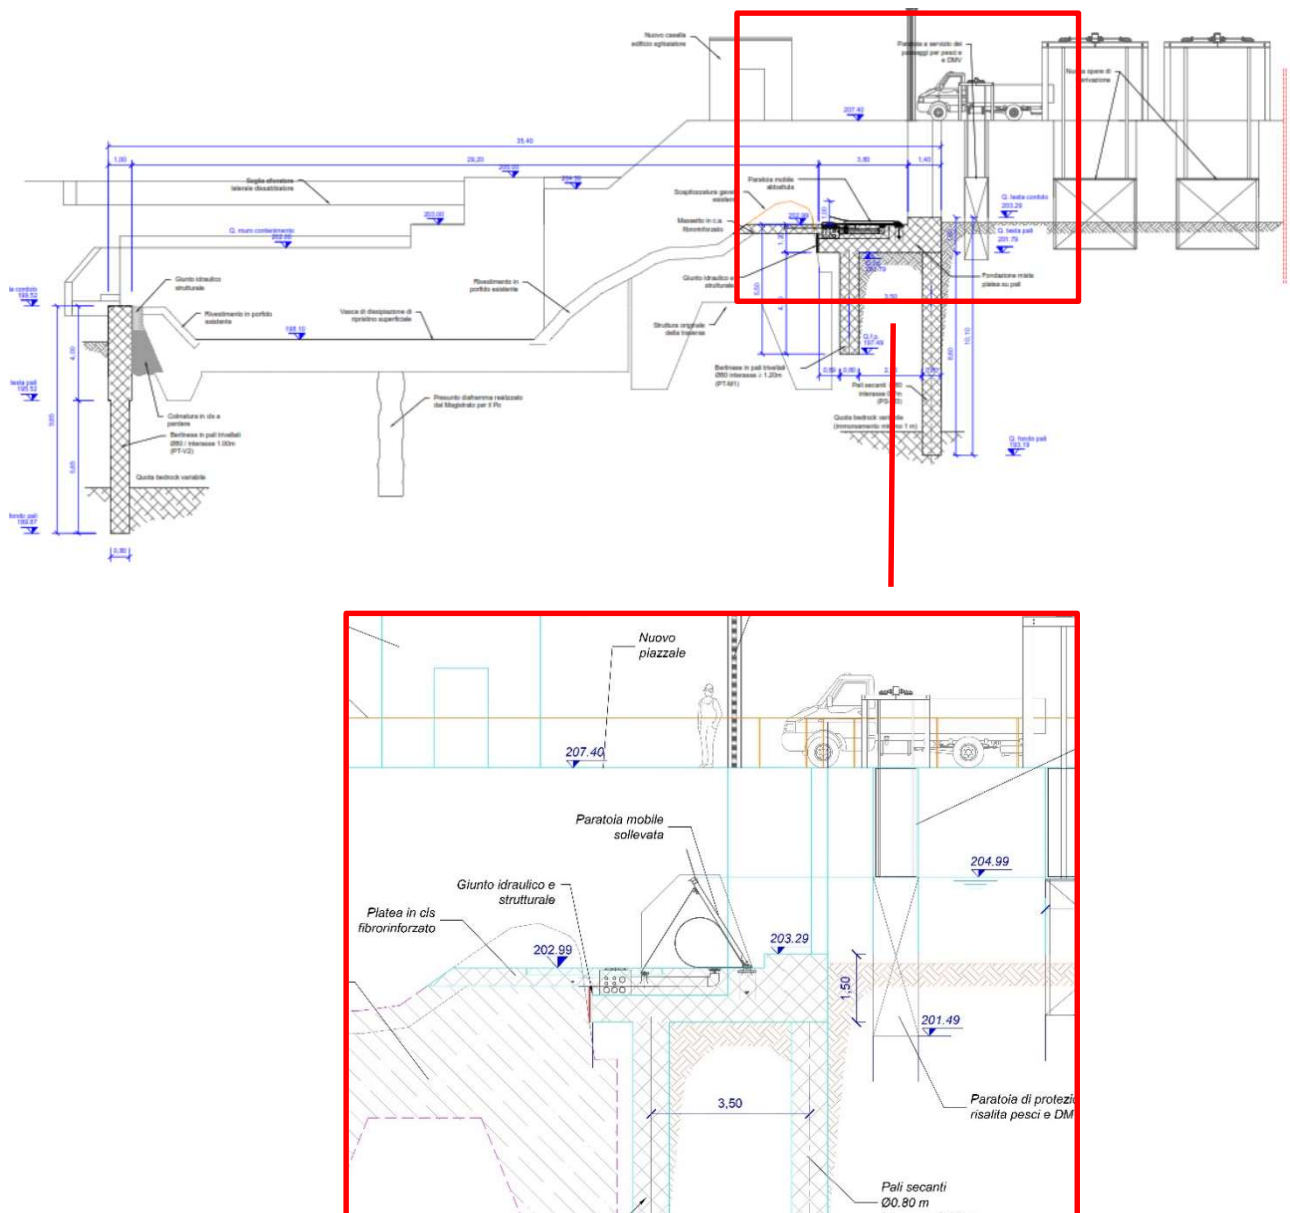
particolare estratto dalle tavole di progetto dell'intervento
